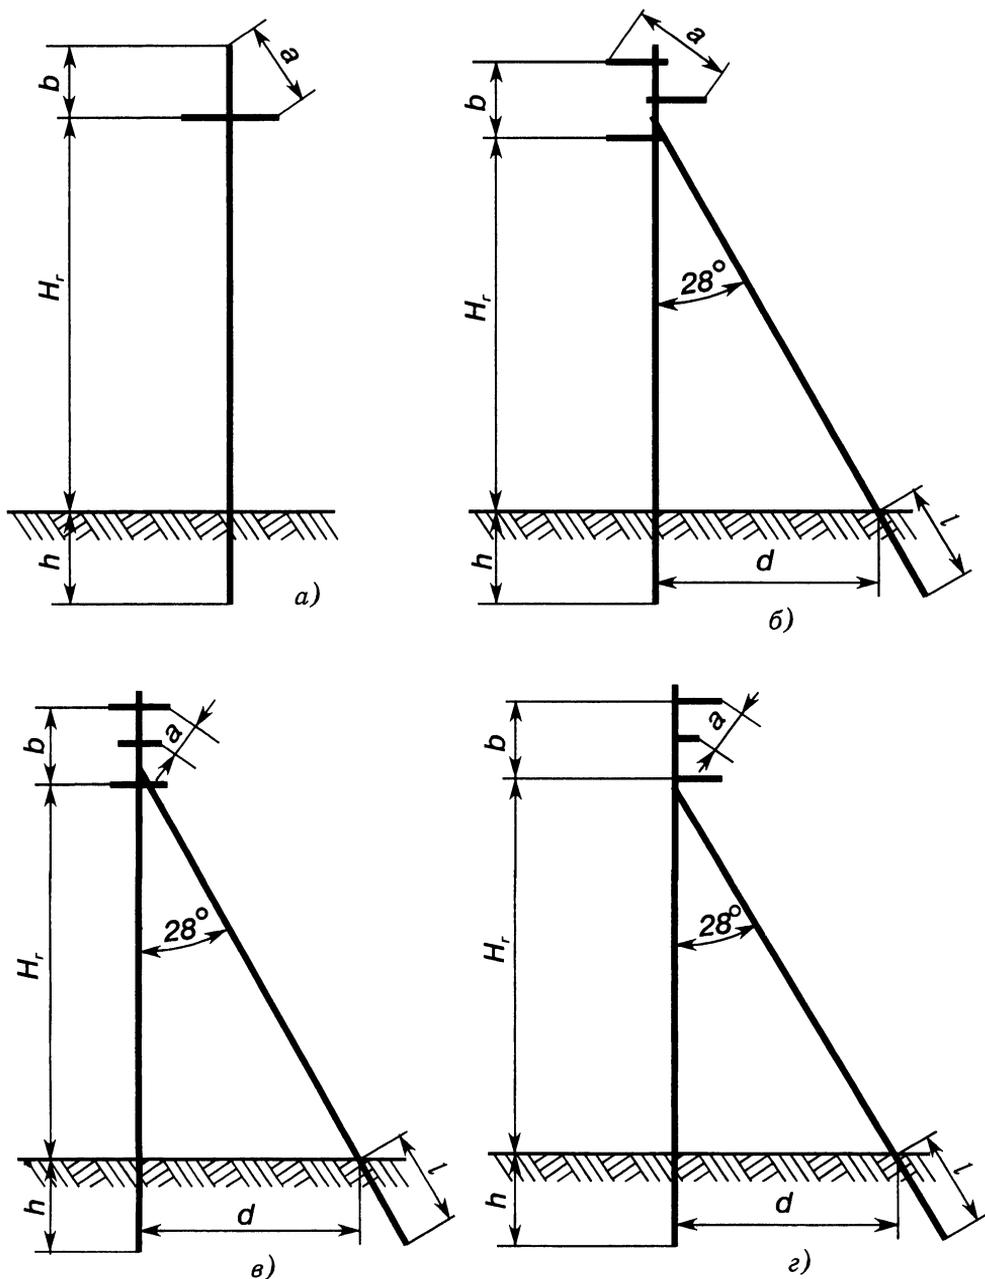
Схемы железобетонных опор ВЛ 6–10 кВ по типовому проекту 3.407–101.
